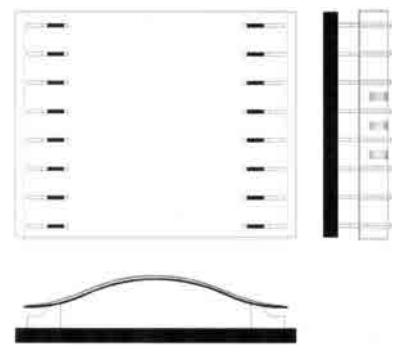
, Fig. 53 y Fig. 54 Gimnasios. Planta, alzado lateral (derecha) y alzado frontal (abajo).
